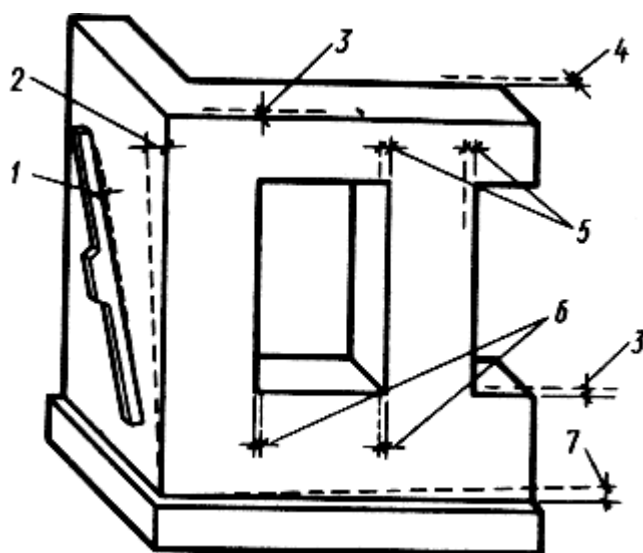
Допускаемые отклонения при возведении кирпичной стены, мм:
